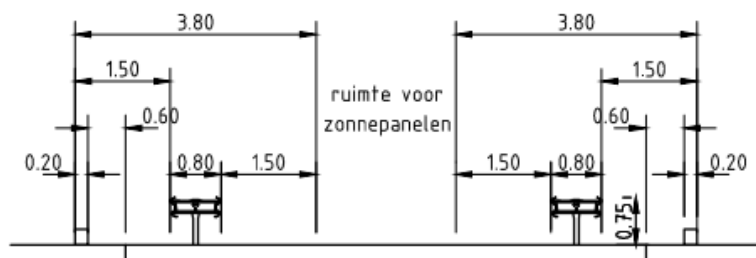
Principe-uitwerking buitenberm met uitstapruimte
